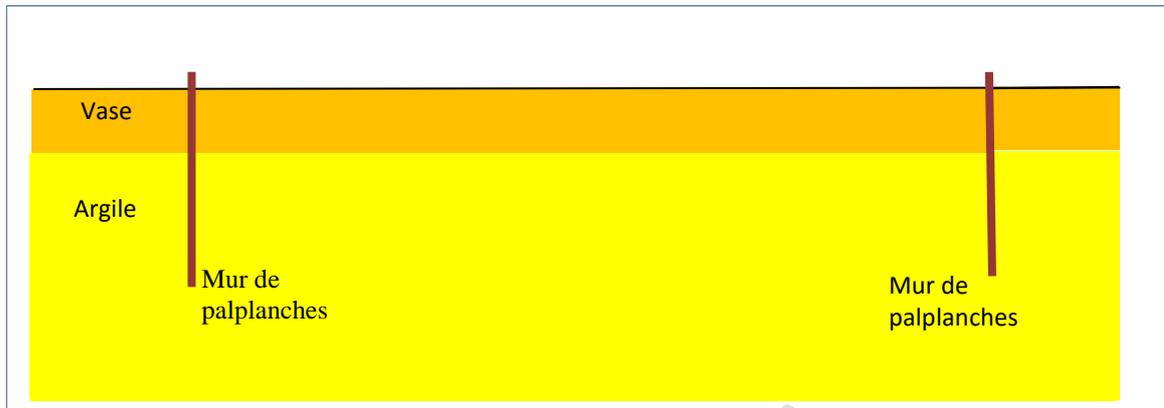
Installation de deux palplanches parallèle (section sur l'alignement de la traversée)
